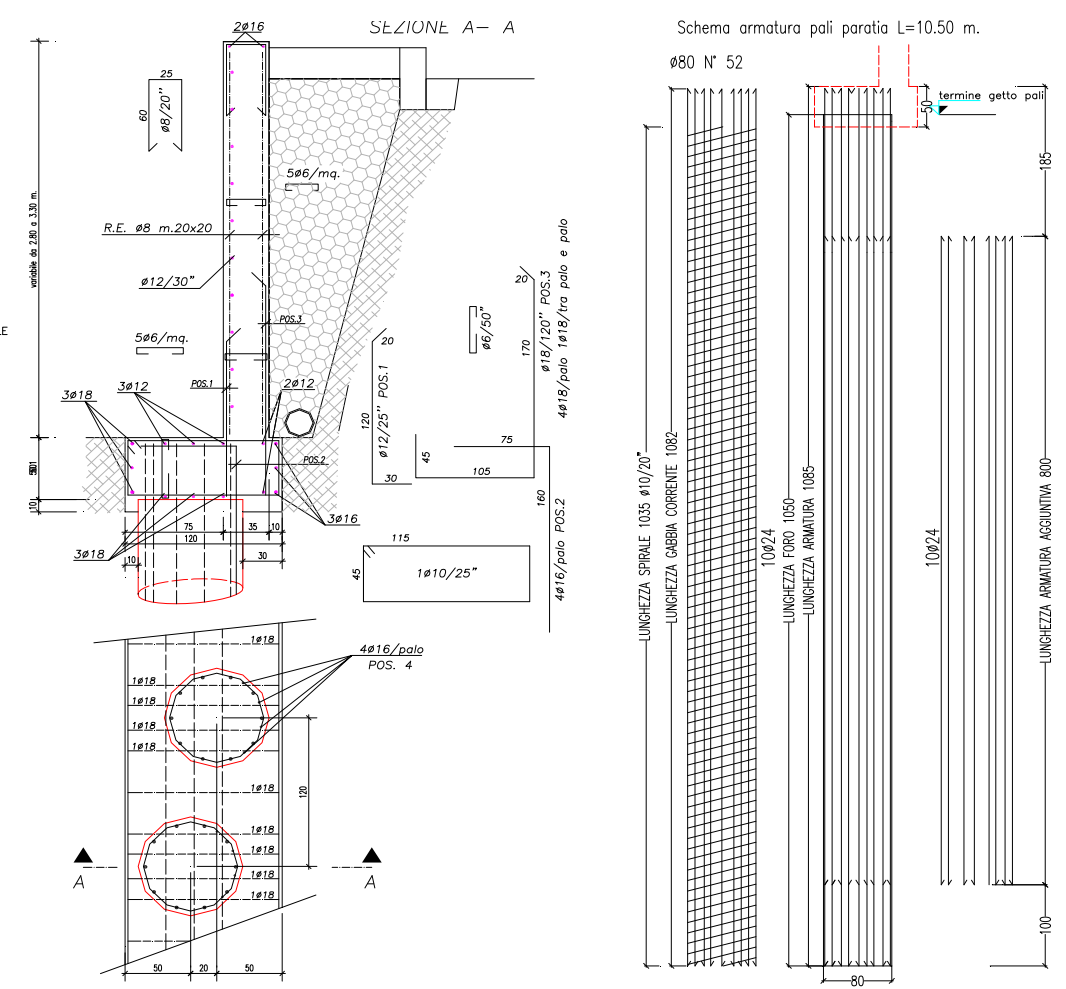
paratia con sovrastante muro a retta del rilevato stradale
